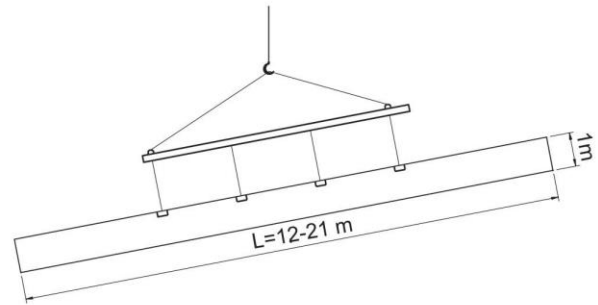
Использование поперечной балки при укладке панелей длиной свыше 12 м.
